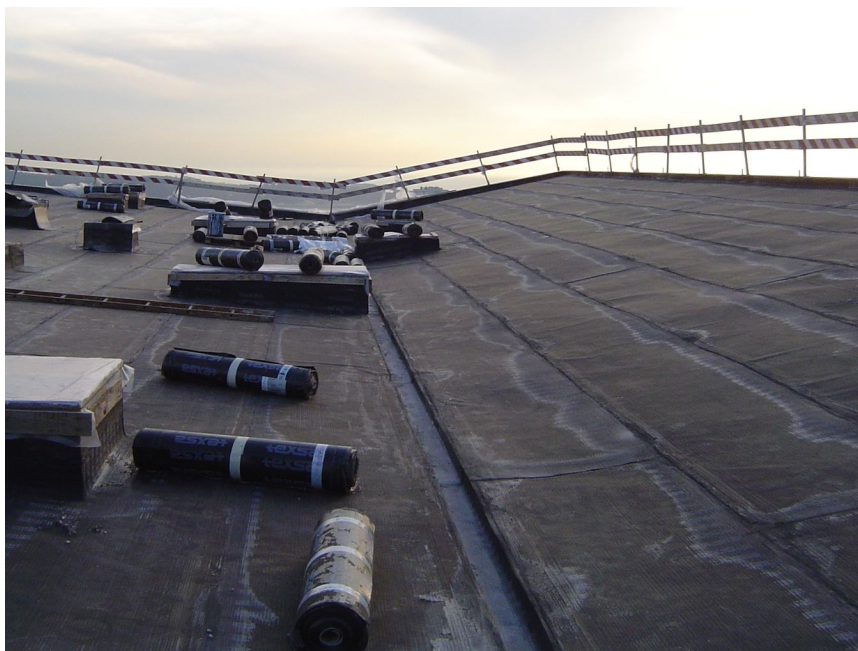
Aplicação da primeira tela de impermeabilização
